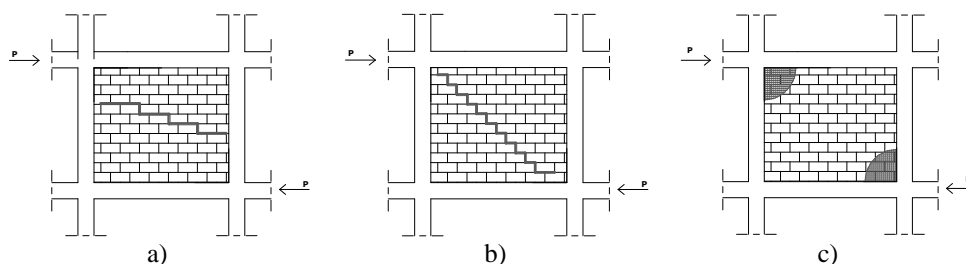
Mecanismos de rotura de painéis de alvenaria: a) rotura ao longo das juntas; b) rotura diagonal; c) rotura por esmagamento dos cantos comprimidos [1]
